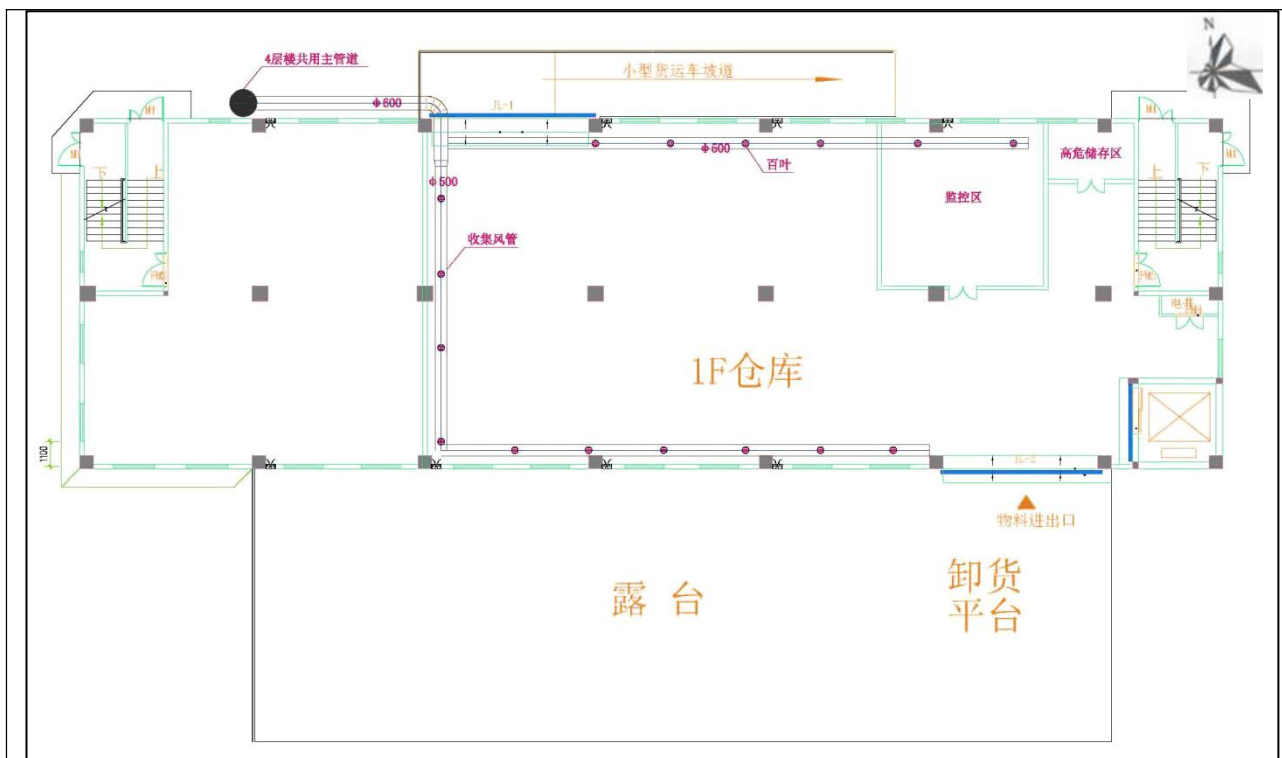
危险废物收集与转运中心1层平面图（总平面图）
